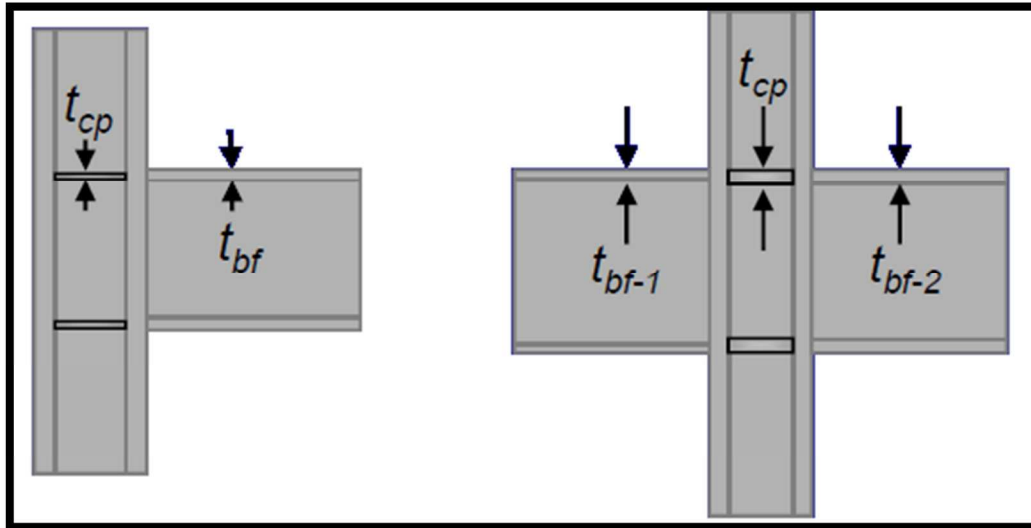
Conexiones Viga-Columna de Pórticos No Arriostrados Especiales
